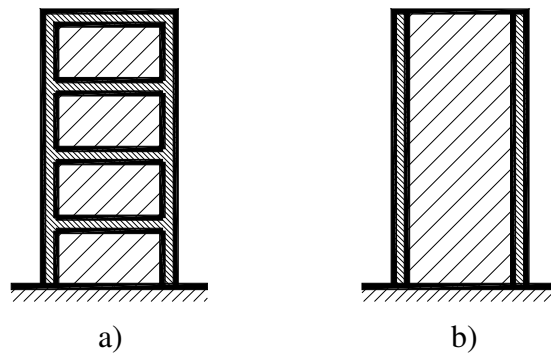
Сталежелезобетонные конструктивные системы.
